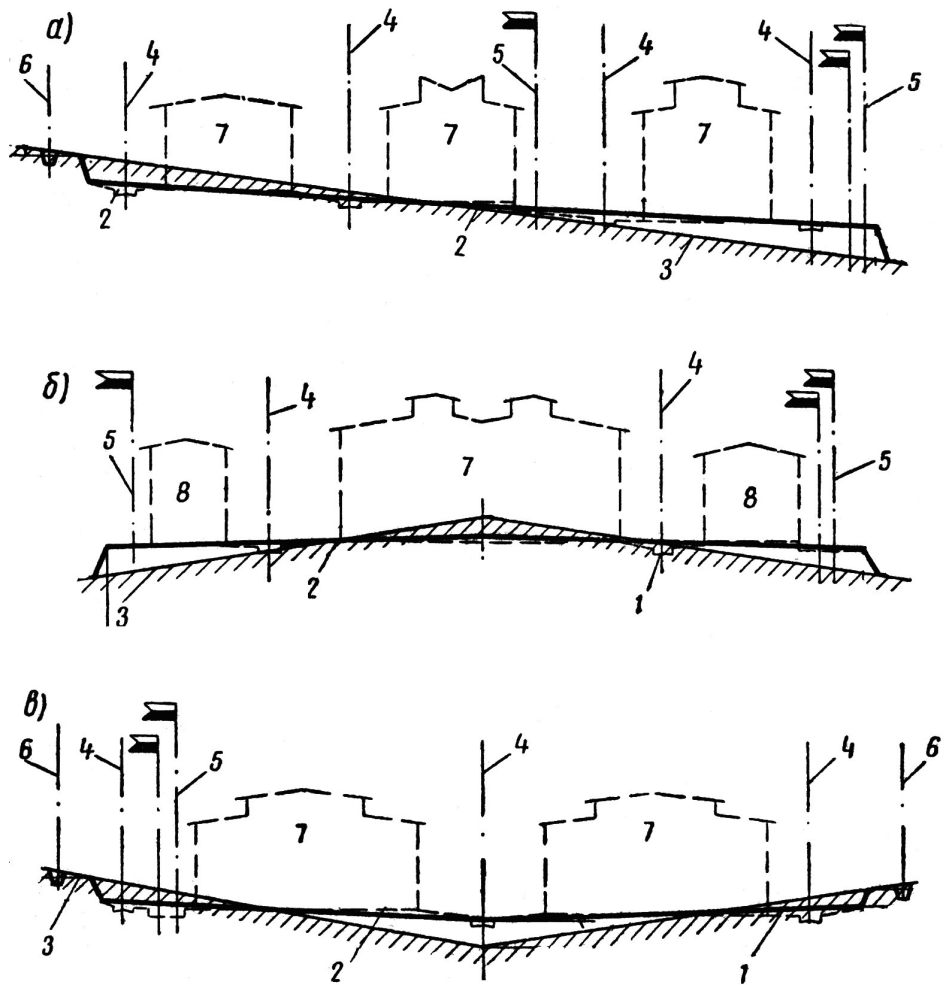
Безтерасові схеми вертикального планування: а) при ухилі поверхні в один бік; б) при ухилі поверхні від середини до меж майданчику; в) при ухилі поверхні від меж до середини майданчика; 1 – лінія детального планування; 2 – основна планувальна поверхня; 3 – існуючий рельєф; 4 – вісь дороги; 5 – залізниця; 6 – нагірна канава; 7 – цех; 8 – склад
